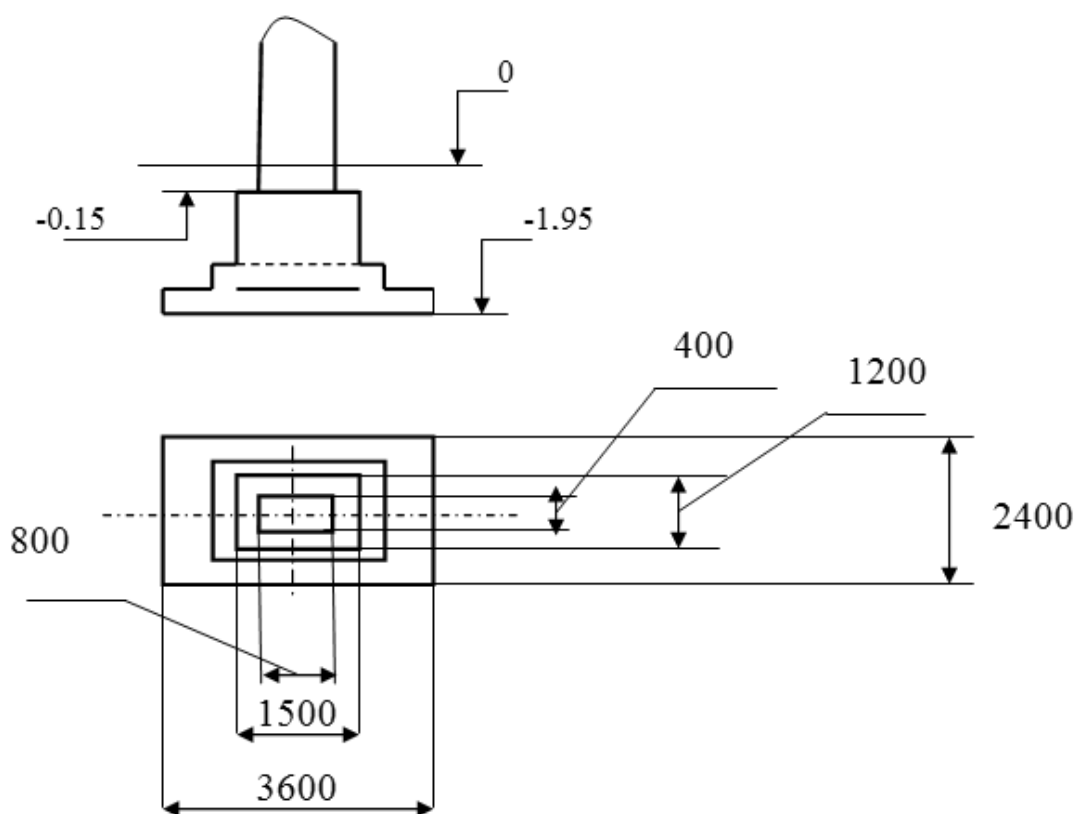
Фундамент под колонны серии КЭ-01-49
